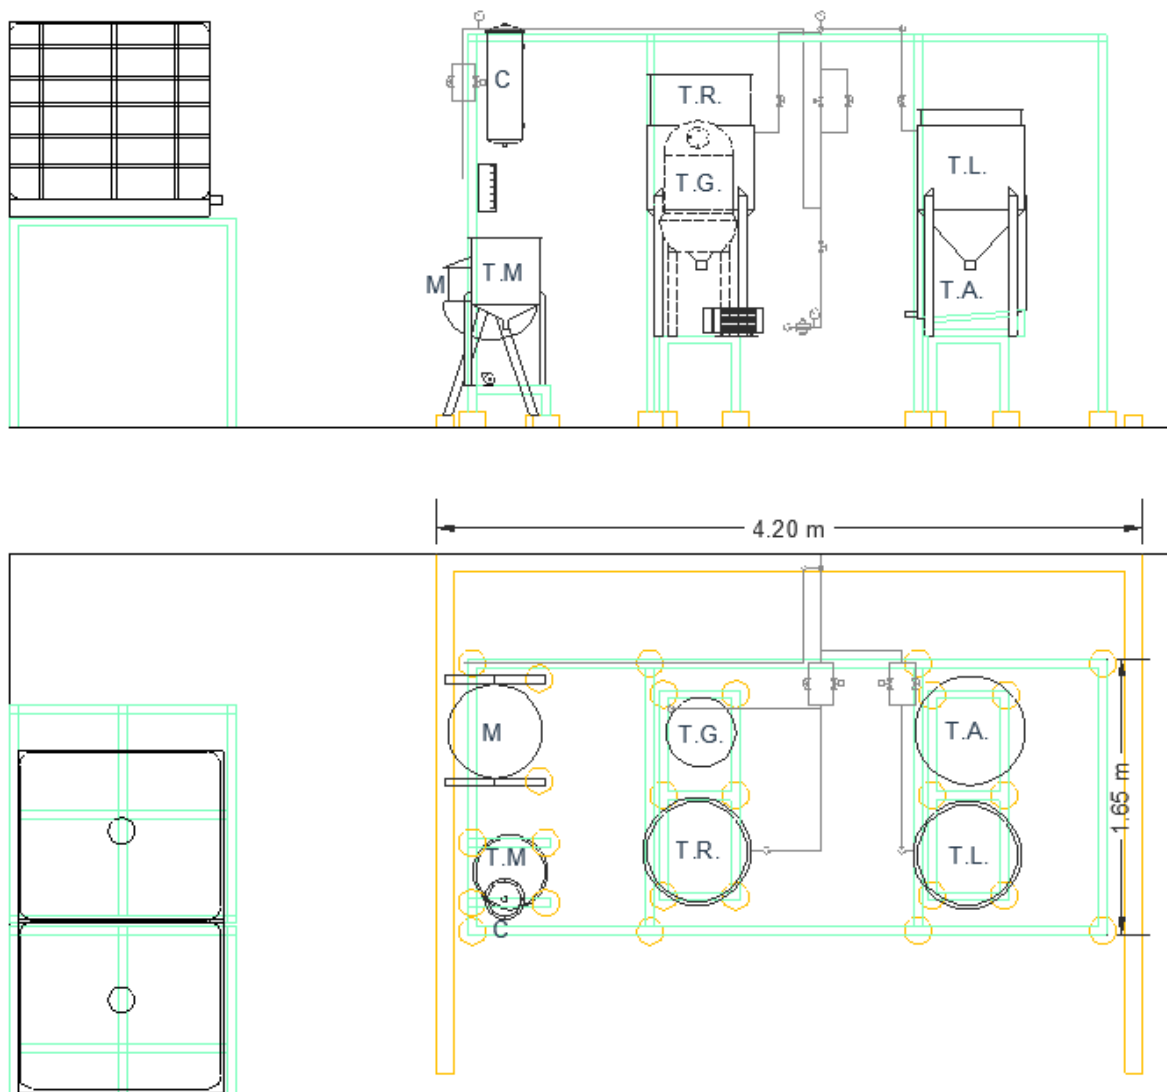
Esquema de la planta mostrando tubería de metóxido de sodio.
